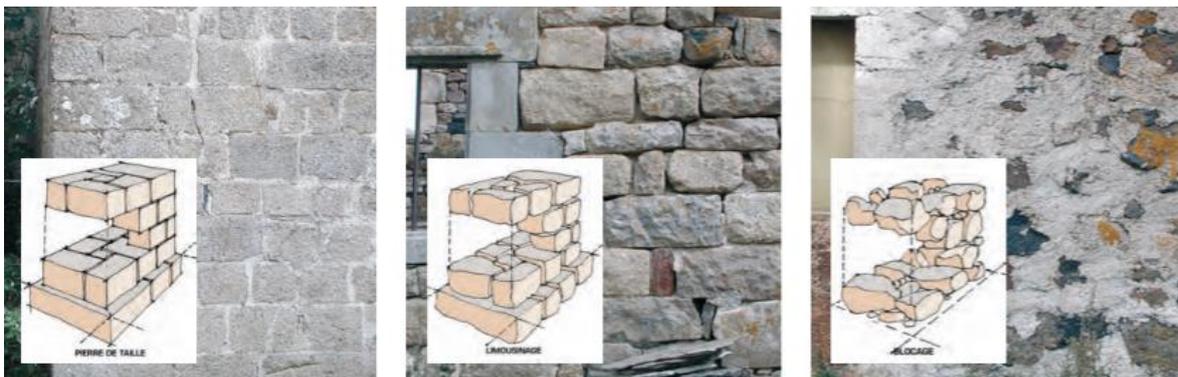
Les différents types d'assemblages en pierre : la pierre de taille, le limousinage et le blocage
